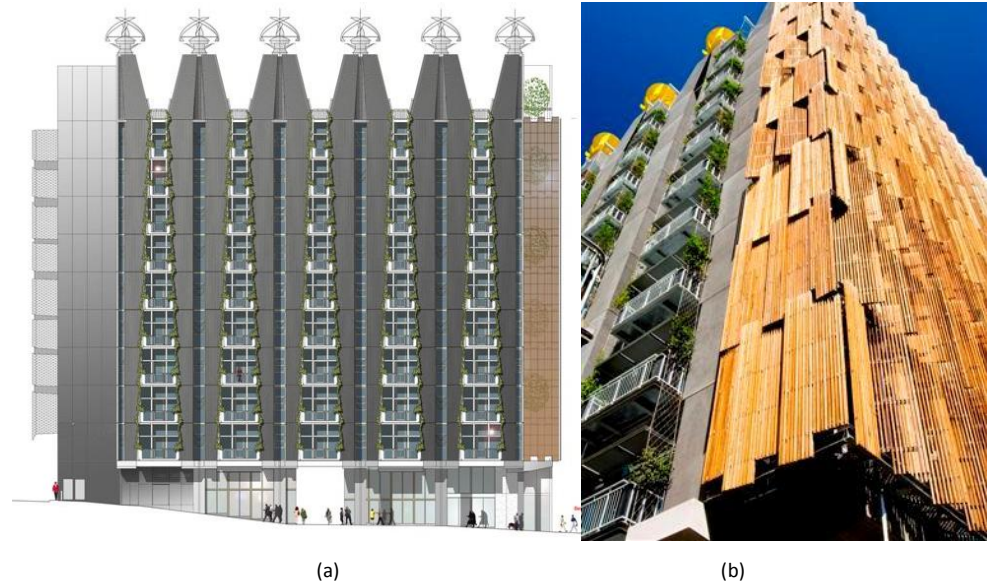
a) Fachada norte do Edifício CH2, com as janelas de tamanhos; b) Fachada norte com os balcões protegidos lateralmente pela vegetação trepadeira e fachada oeste, com brises móveis de madeira (Fonte: PLATAFORMA ARQUITECTURA, 2012)
